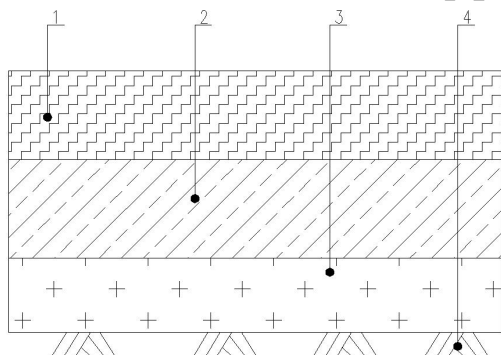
全透式透水水泥混凝土停车场、广场路面结构示意图
